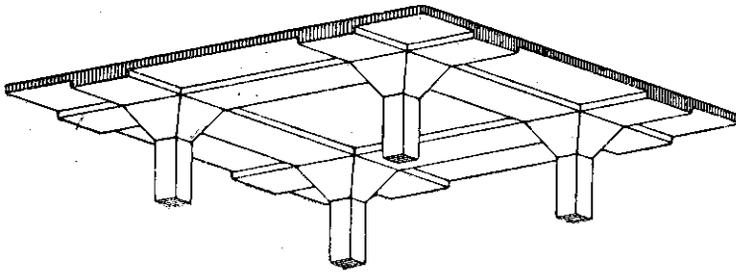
Монолитный железобетонный скелет образуется из стоек, балок и перекрывающей их плиты; все элементы связаны между собой. Утолщения балок в местах примыкания называются вутами.
